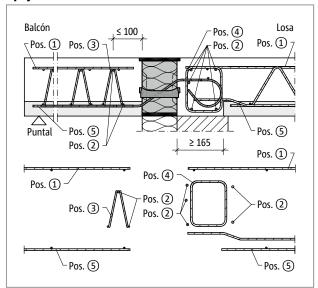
Schöck Isokorb $^{\circ}$ XT tipo Q-V1 hasta V4: Armadura in situ con viga de celosía
